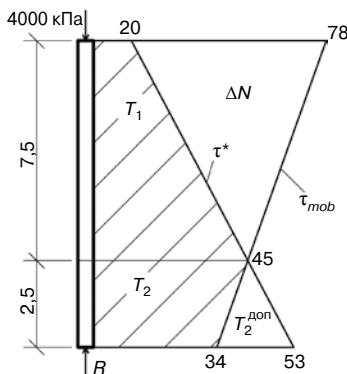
Расчетная схема определения НДС одиночной грунтоцементной сваи при нагрузке 4000 кПа
